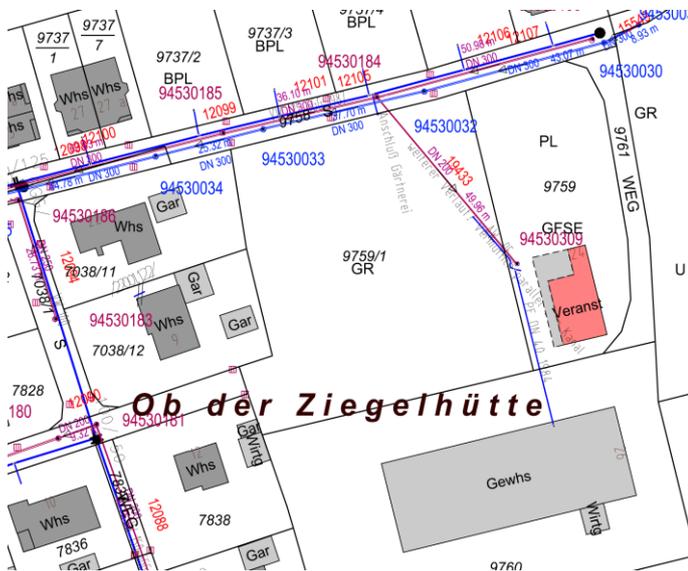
Auszug aus Wasserleitungs-/ Abwasserkataster, unklare Leitungstrasse
